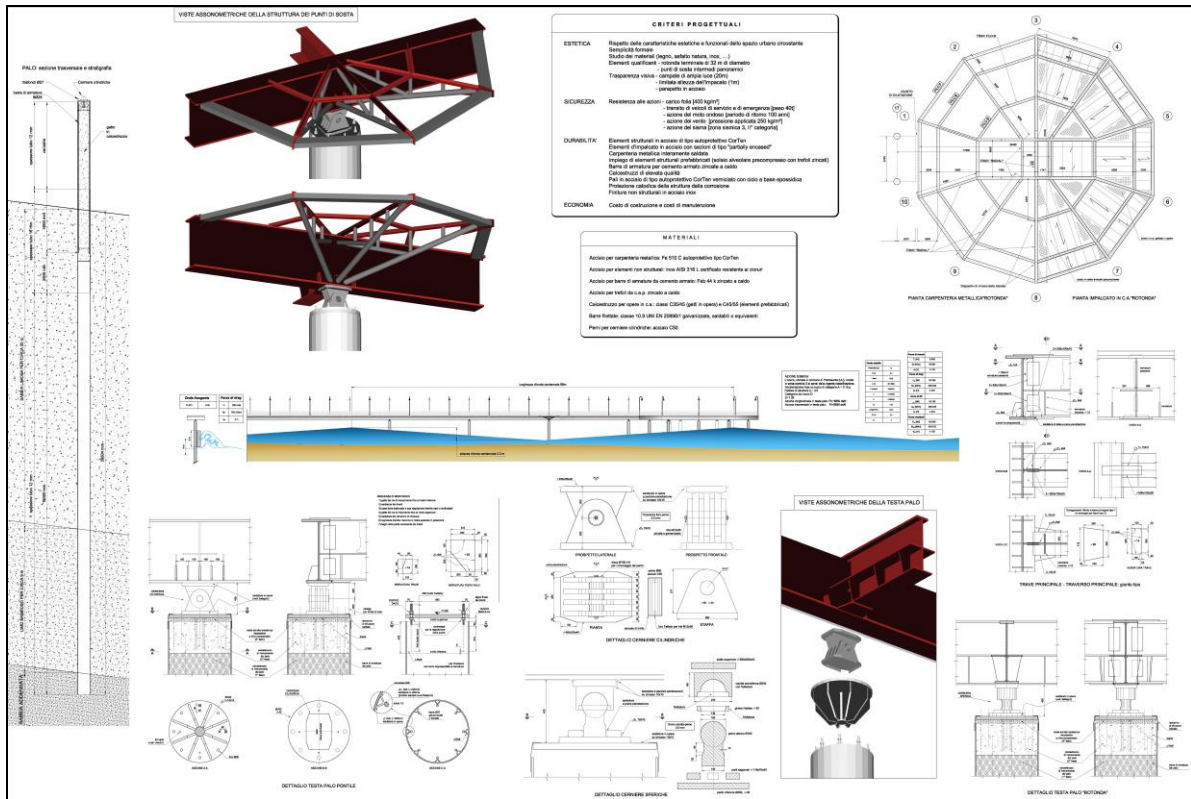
il pontile di Marina di Pietrasanta (LU)
